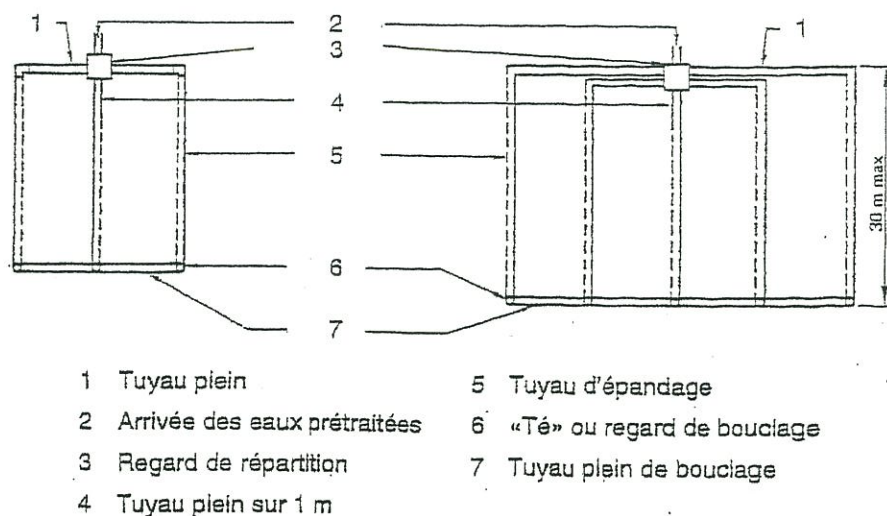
Vues en plan ; exemples à 3 et 5 tranchées
